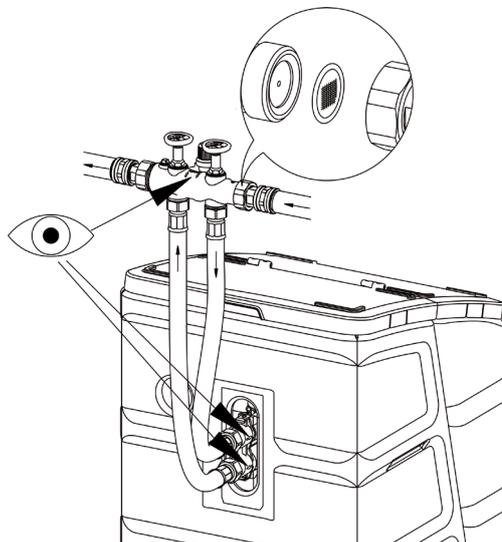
Raccordement sanitaire Weichwassermeister GSX
